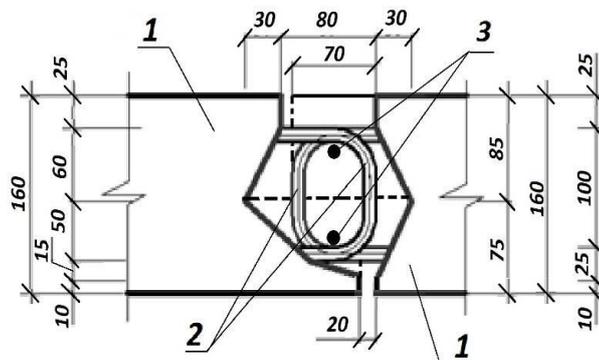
Конструкція з'єднання плит перекриття між собою 1 – плита; 2 – арматурні випуски; 3 – арматурні стержні А500 діаметром 10 мм
